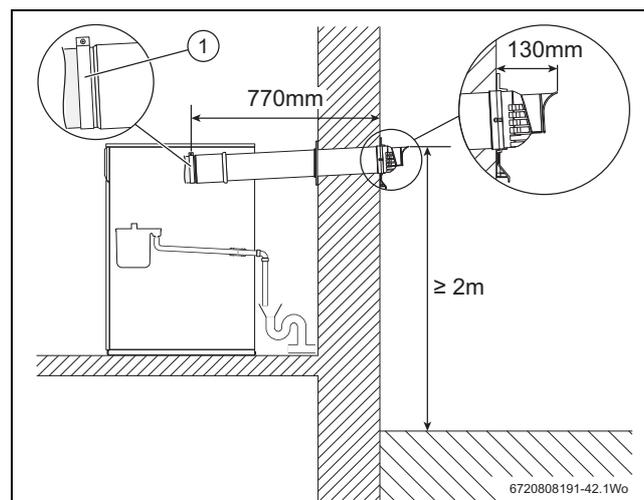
1 kit conduite d'évacuation des fumées de type ventouse horizontale Longueur = 950 mm
